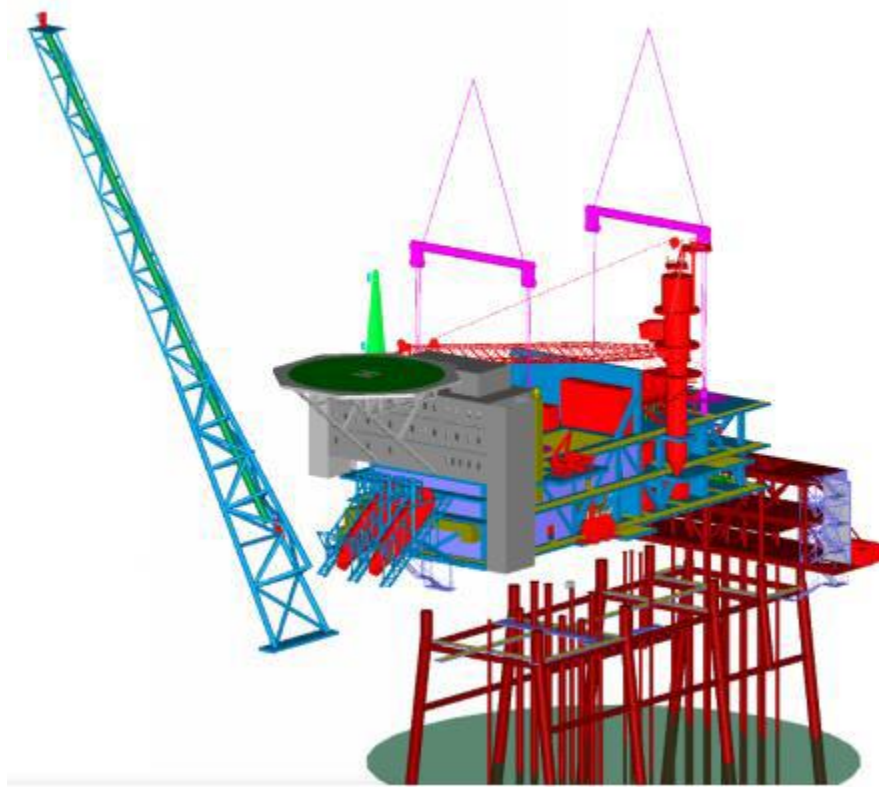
(#) viser et overblik for Hejre-platformen, hvor struktur med mørkerødt er struktur installeret i 2014.
